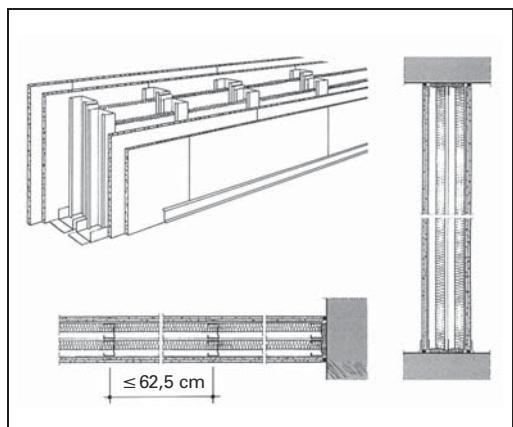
Metallständerwand als Doppelständer-Werk, zweifach beplankt
